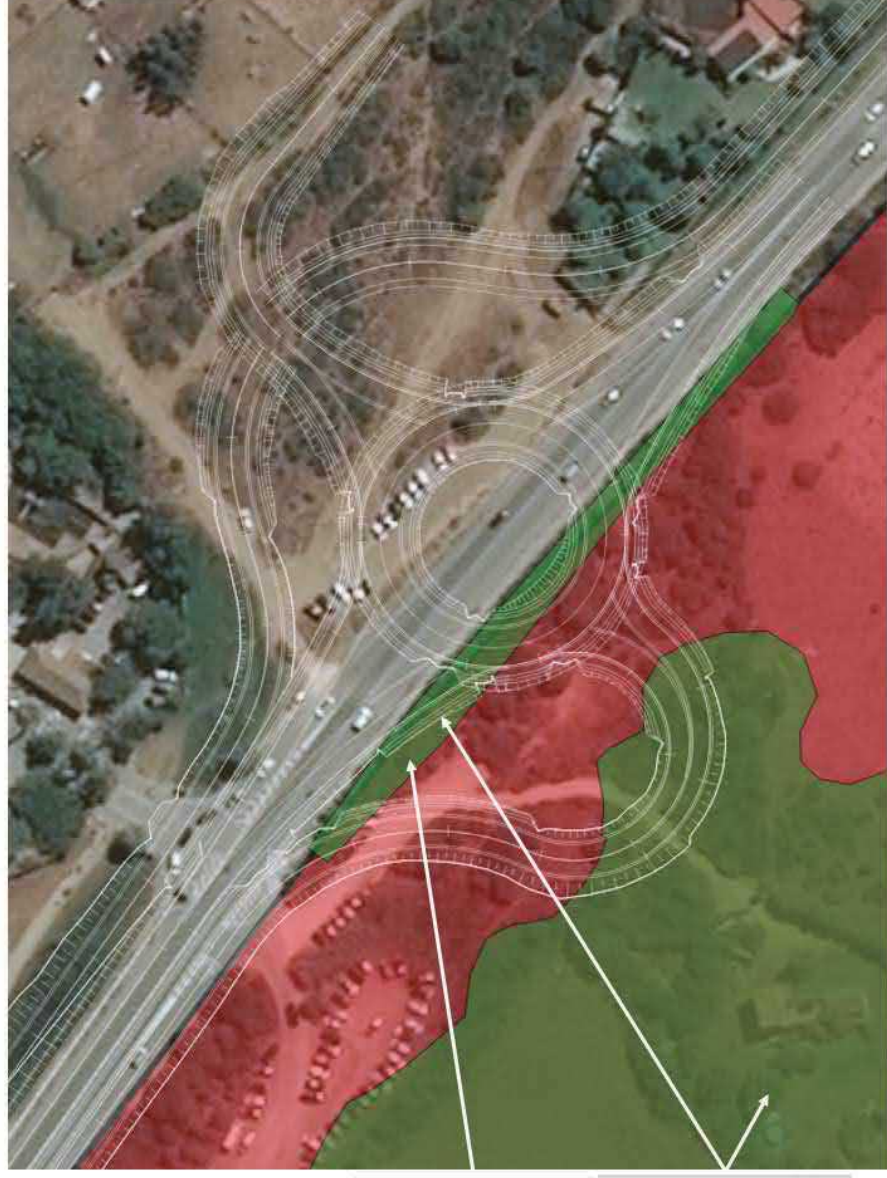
Espacio ZEPA Estrecho, HICs identificados y planta de proyecto
